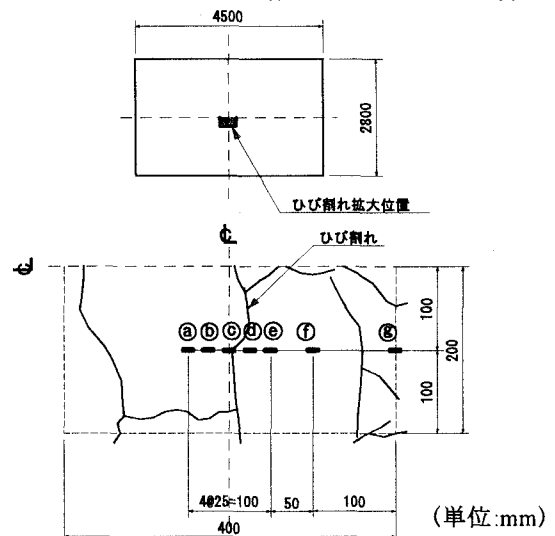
ひび割れ近傍のひずみゲージ貼付位置
